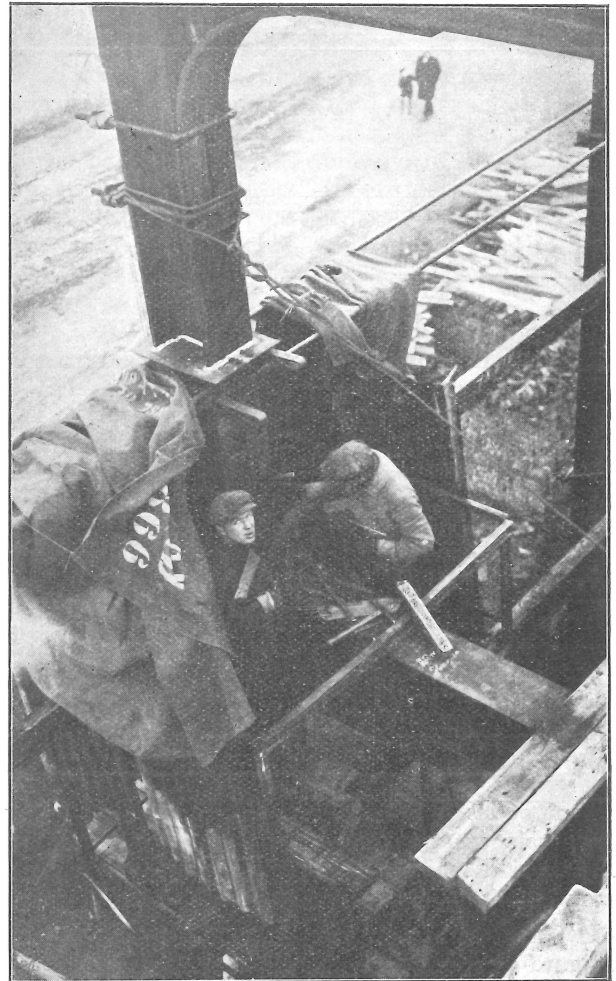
Soudure au chantier d'un assemblage de poutre du laboratoire d'hydraulique (1932).
